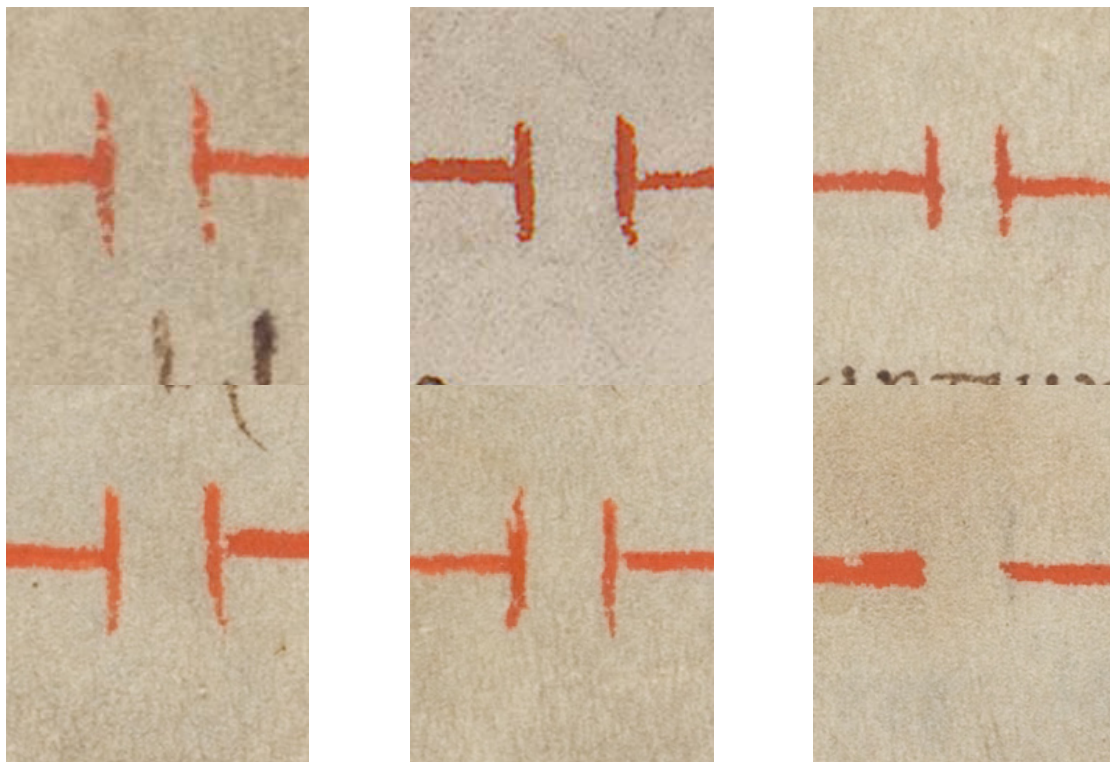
Abtspalast Nebengebäude – Details Türöffnungen
